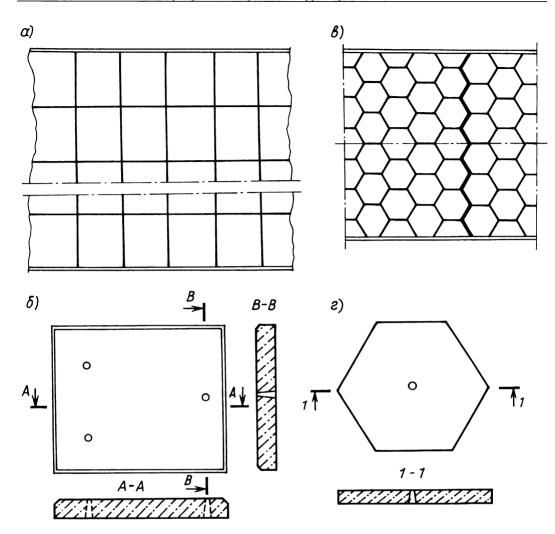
Дорожные покрытия из плит различной конфигурации: A- прямоугольные плиты на проезжей части; B- план и разрез плиты; B- план и разрез шестигранной плиты
